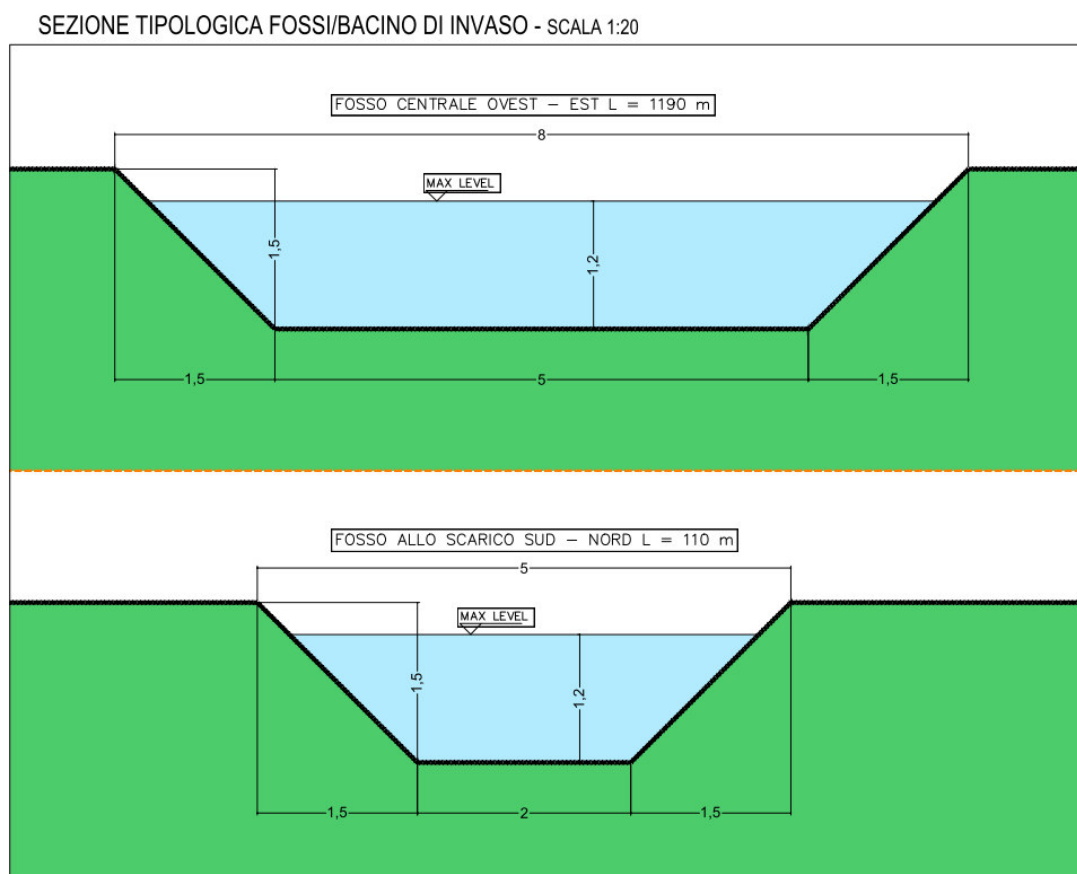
Sezione del fossato centrale e scolina a nord – stato di progetto
